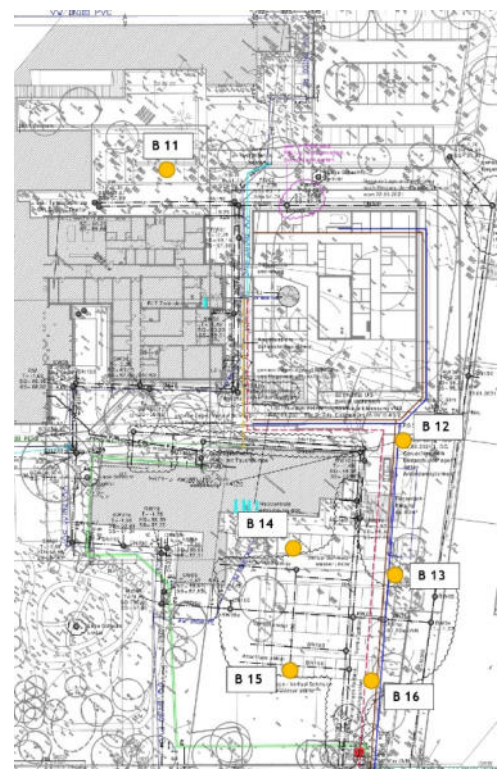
Bohrprofile und Lageplan der Erkundungsbohrungen
